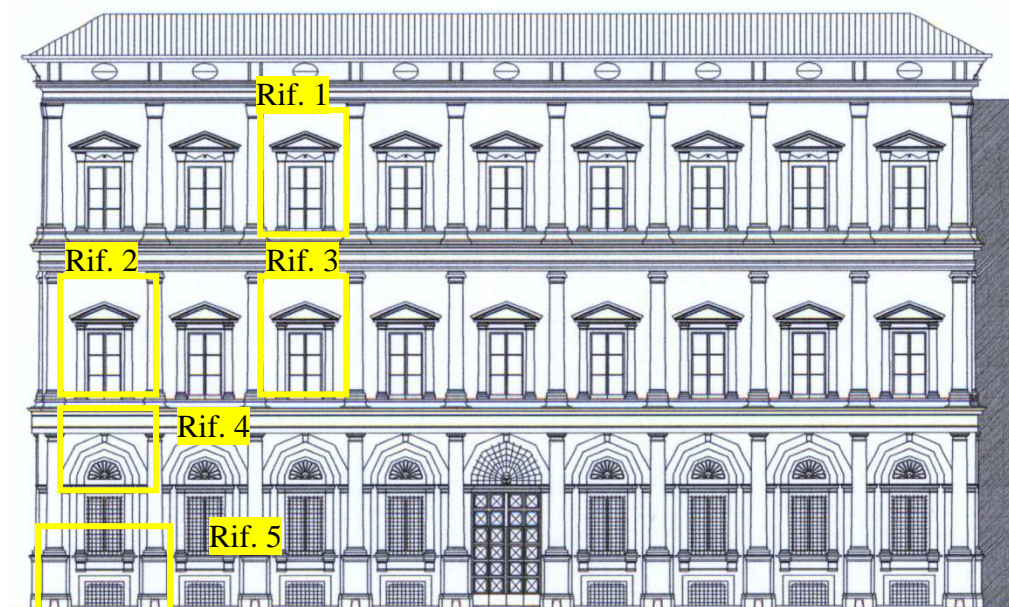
Prospetto dell'edificio su via Zamboni.
